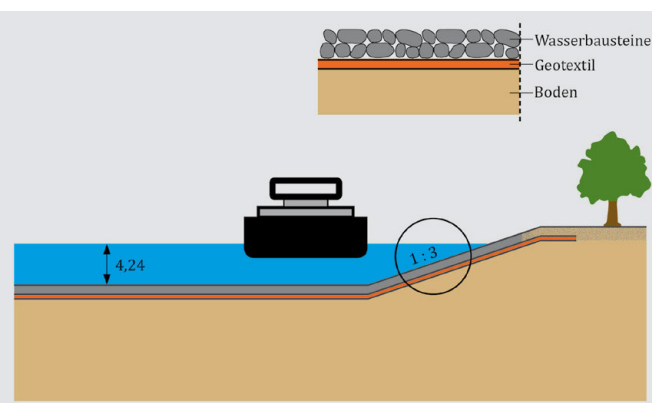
Geotextilanwendung nach DIN EN 13253 [3] – Deckwerksbau an einer Binnenwasserstraße
